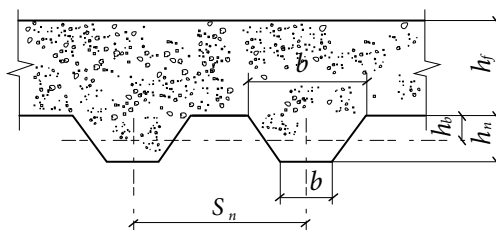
Схема для определения приведённой толщины бетона
